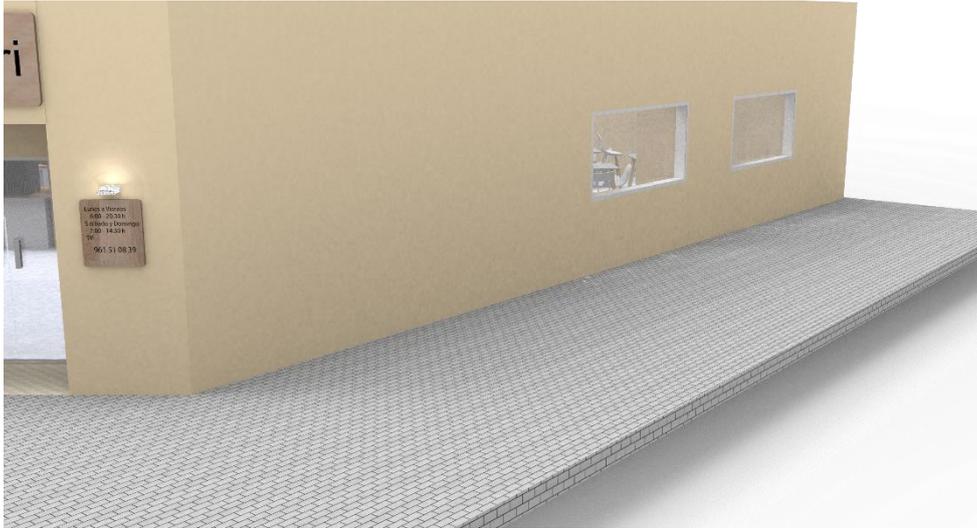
Imagen 332. Renderizado fachada parte derecha.
